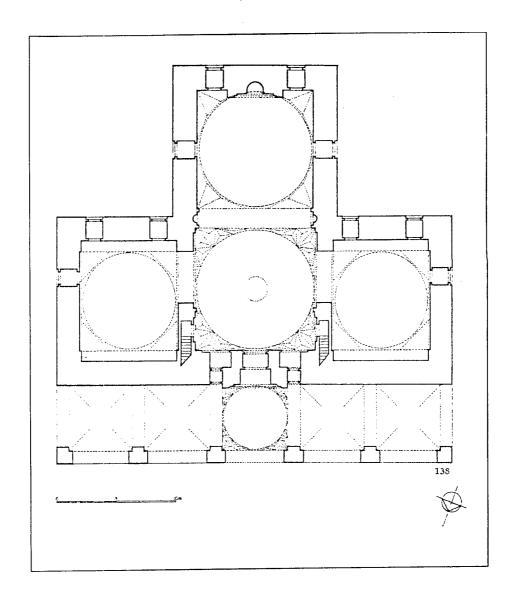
مسقط أفقي لمسجد فاتح باشا بديار بكر (عن: اصلان ابا)
